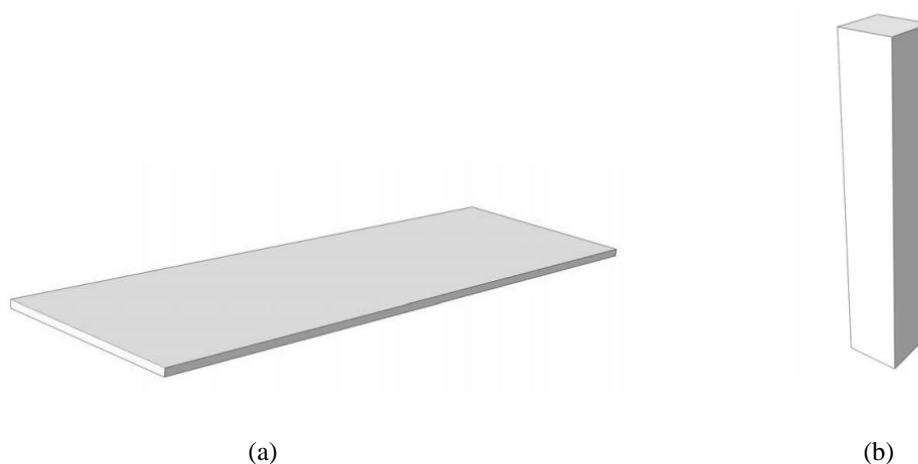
Elementos de laje (a) e de pilar (b) do modelo.
